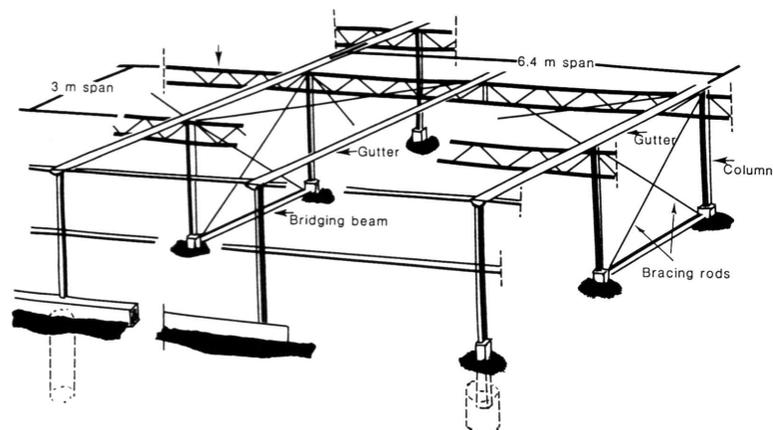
Detalles de las fundaciones de los postes en una estructura Venlo. Se puede notar la utilización de bloques cilíndricos de hormigón, de diferente longitud y diámetro, según la ubicación del poste y su exposición. Hanan. 1998
